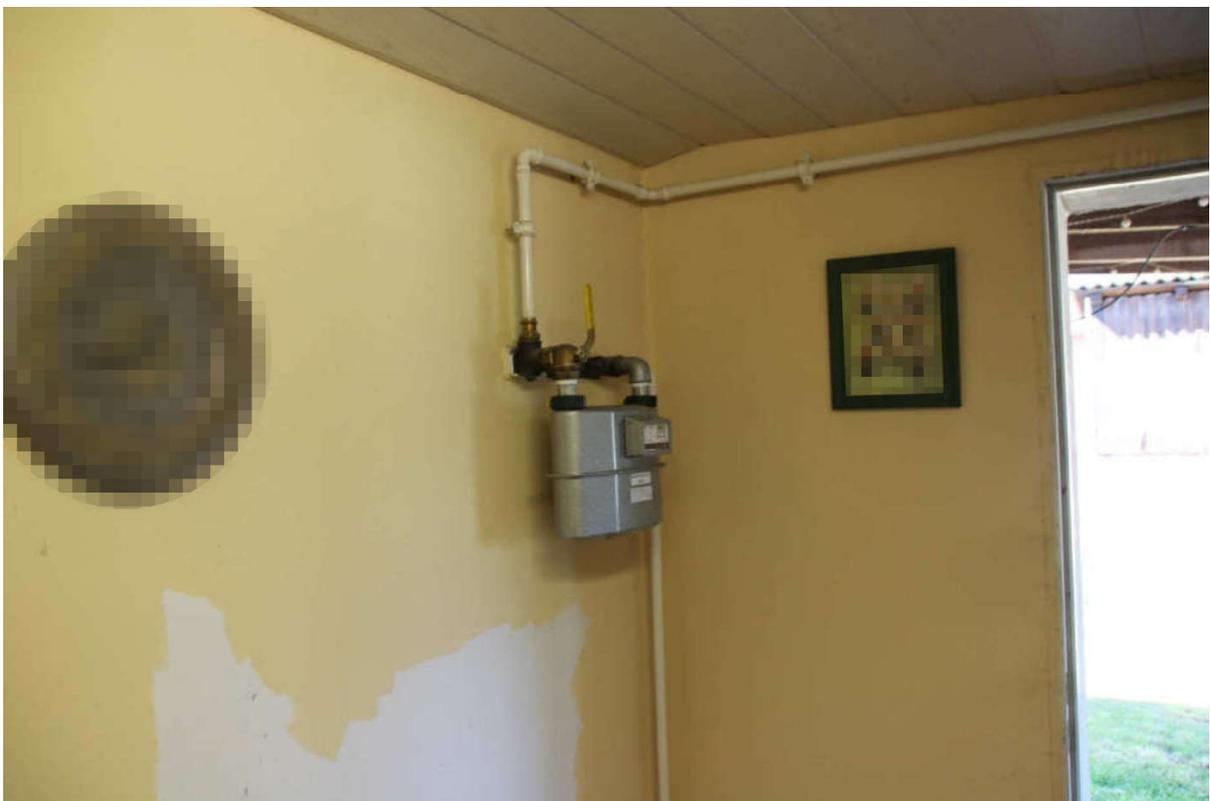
und Bild 34: Gästezimmer im Erdgeschoss
